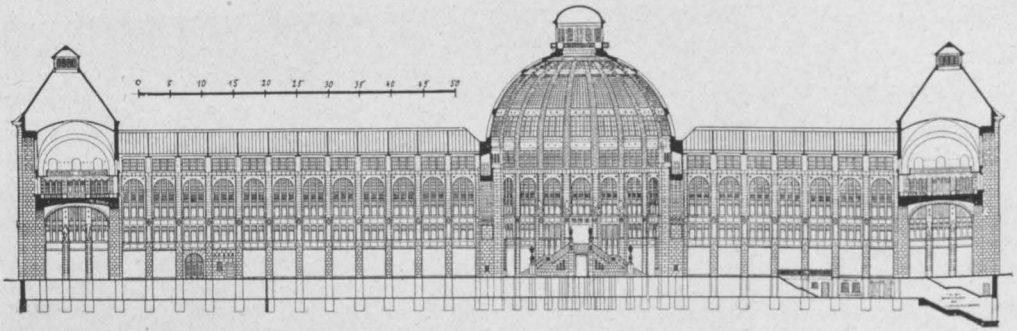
Passage-Kaufhaus Berlin. Längsschnitt \*).
